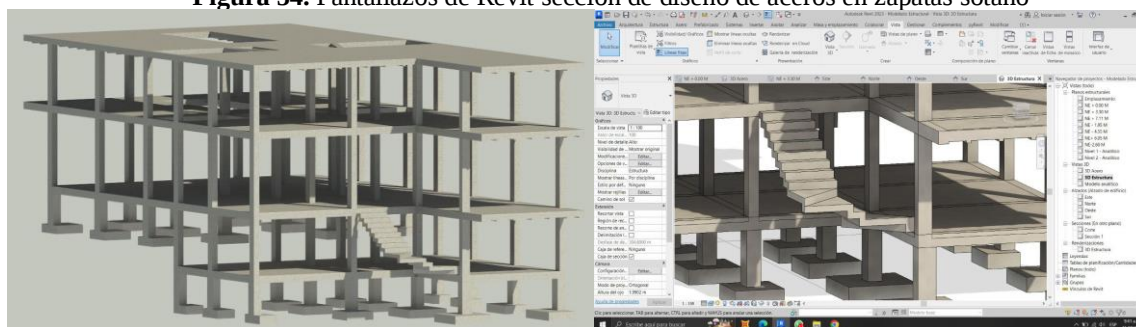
Pantallazos de Revit Pórtico de la obra Casa de la Cultura
